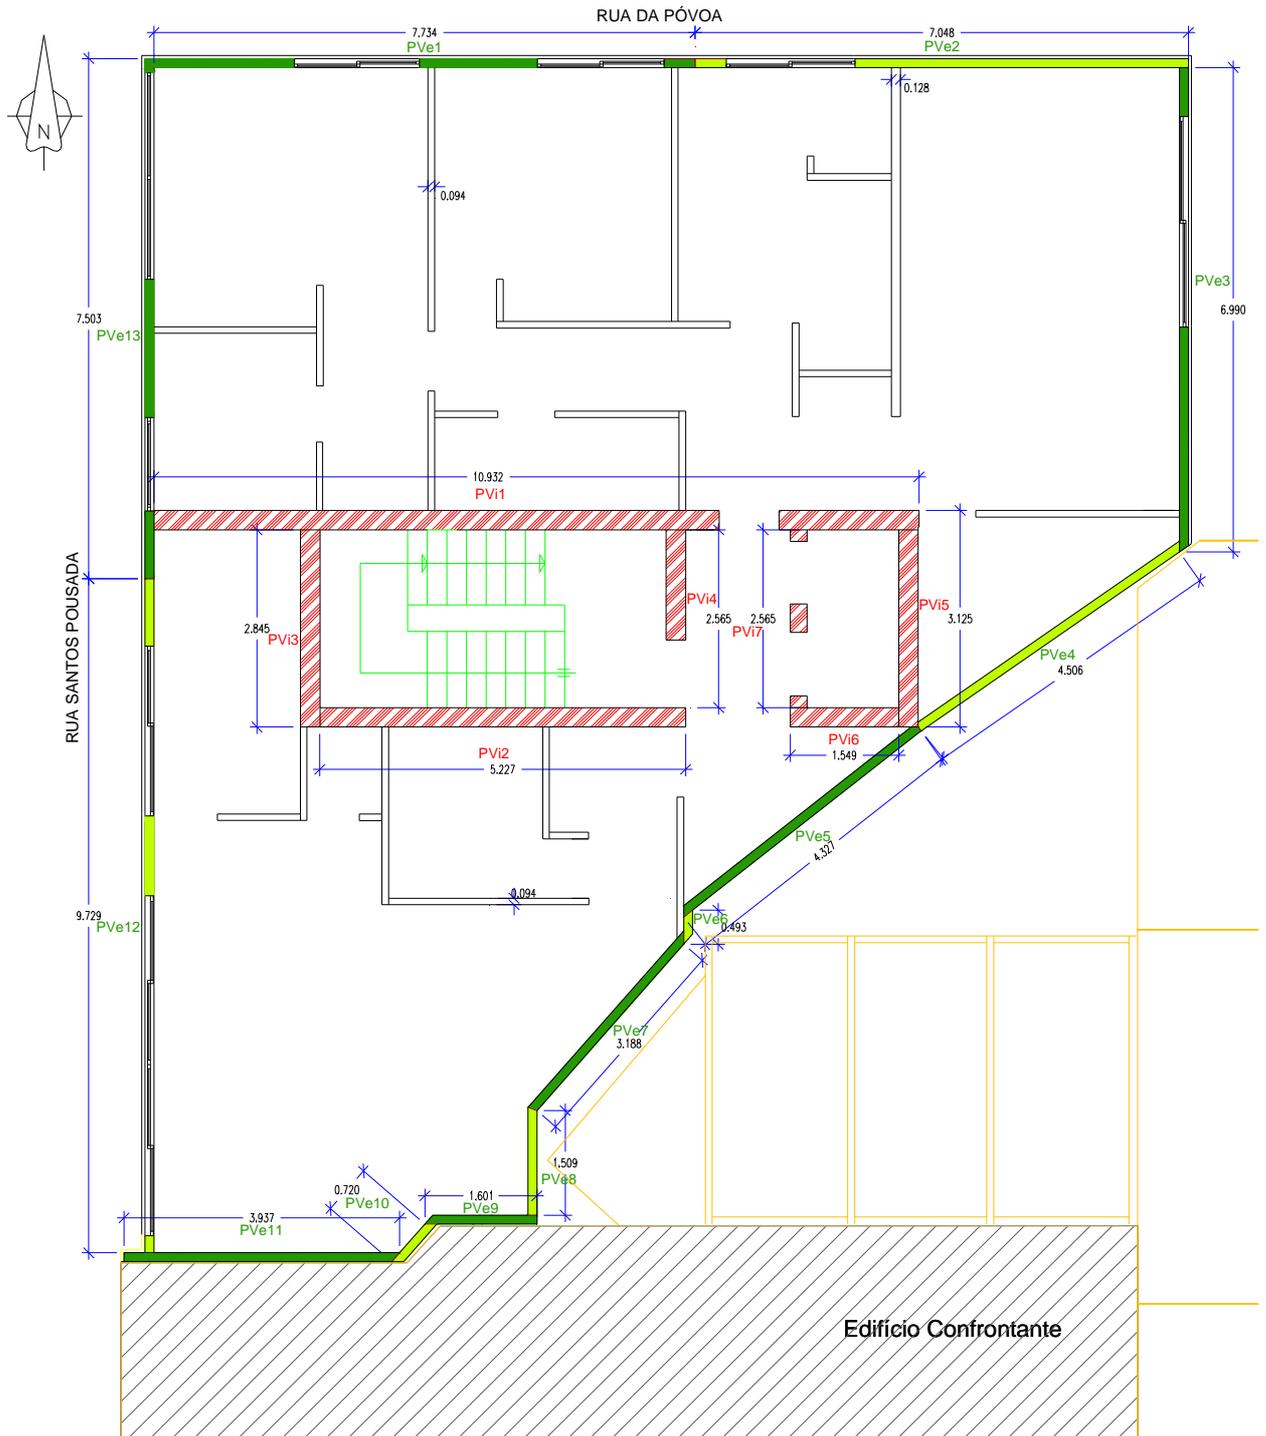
Planta de painéis verticais exteriores e de painéis do núcleo – piso-tipo
